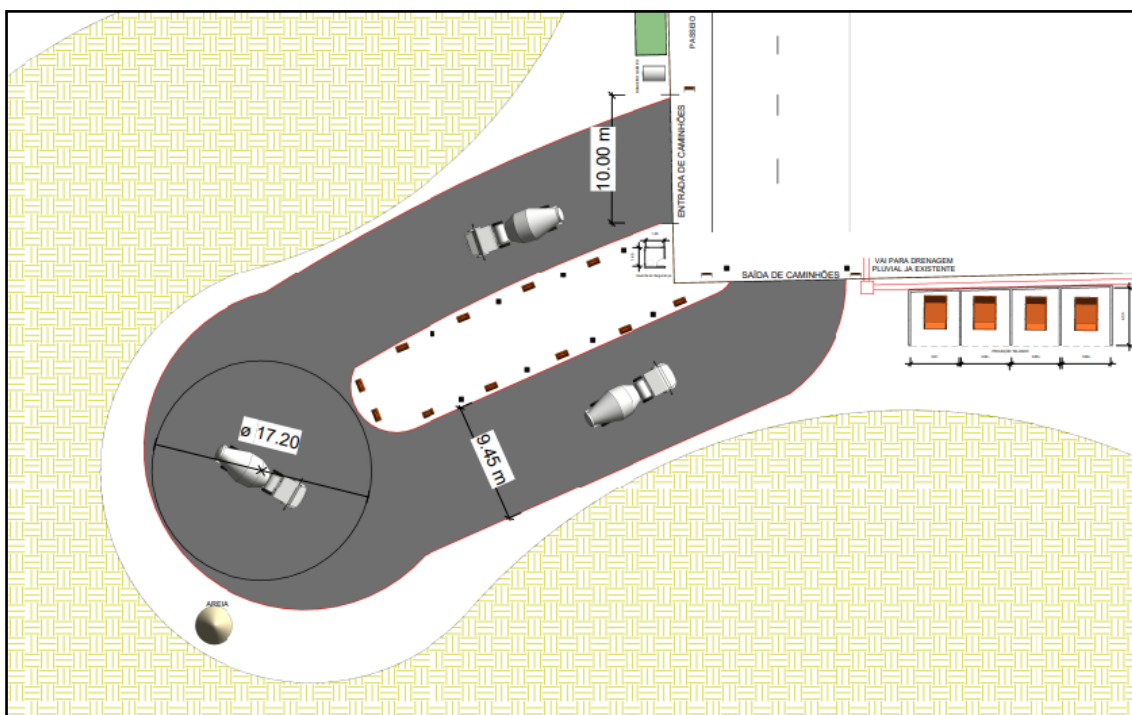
Acesso de caminhões ao canteiro de obras do empreendimento. Fonte: Projeto Canteiro de Obras, 2025.
